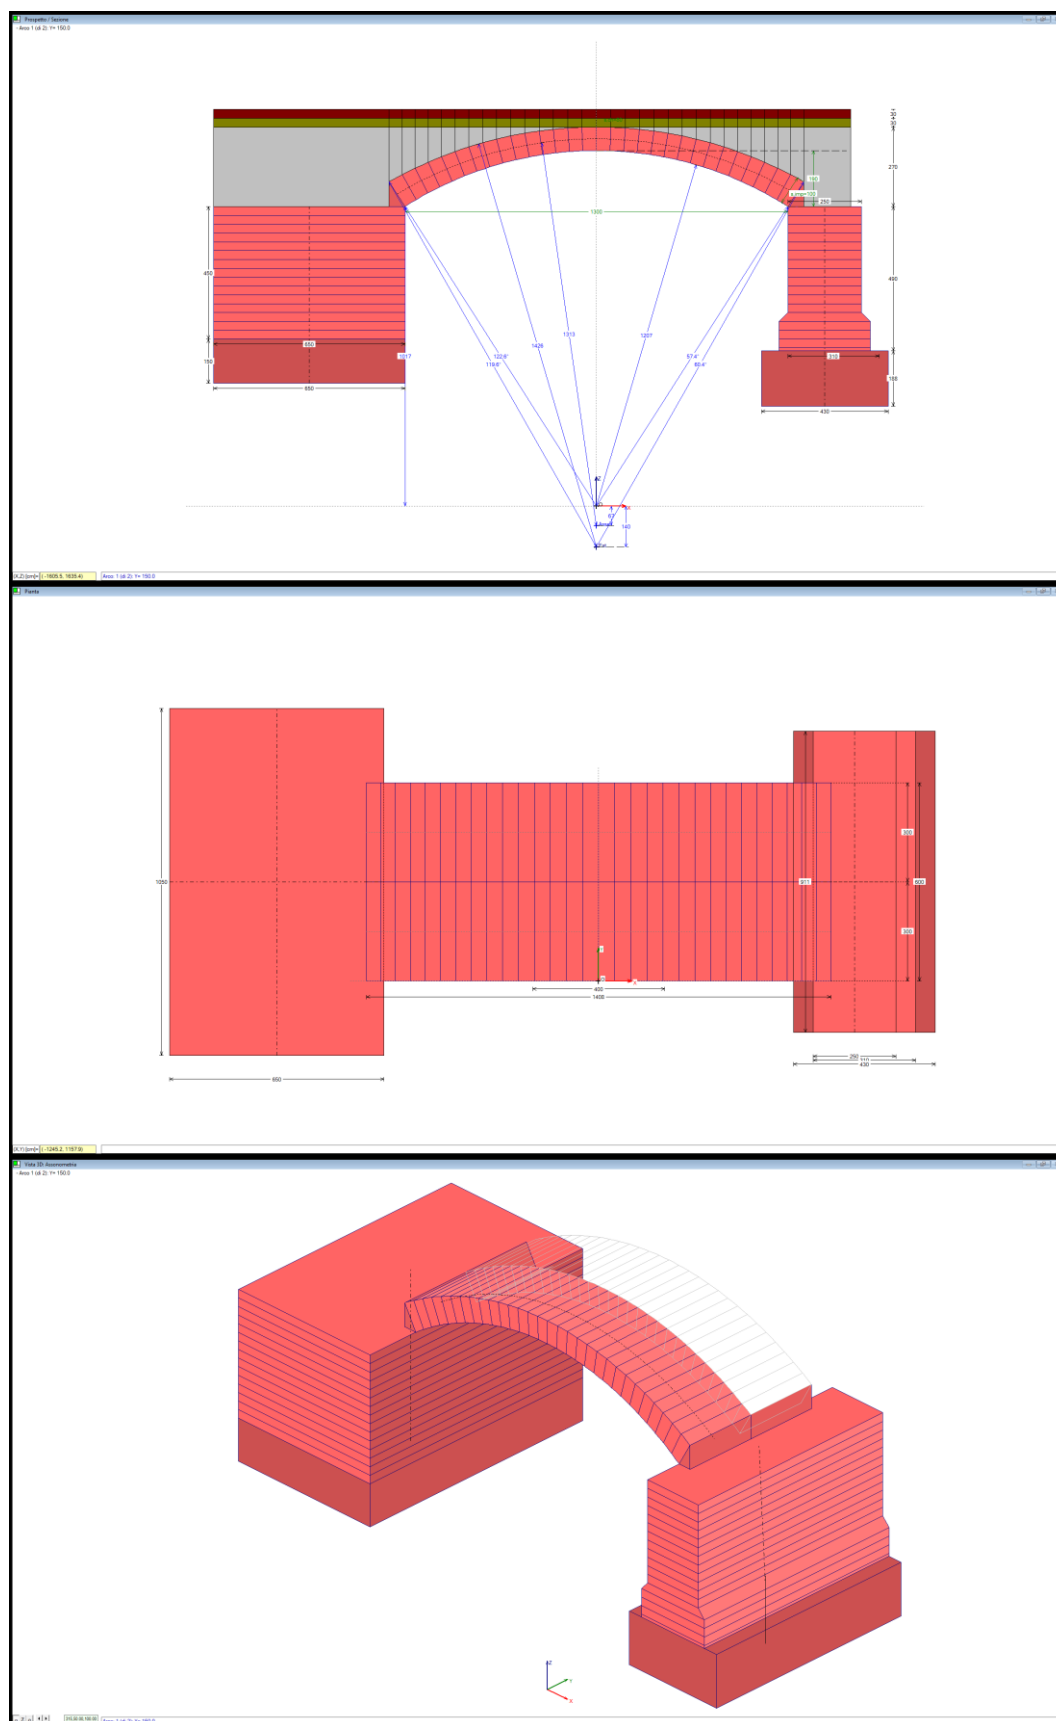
Modelli Ponte-Lanzo-R0\_SX-Fase1 e Ponte-Lanzo-R0\_SX-Fase2 – Prospetto, pianta e assonometria (dall'alto in basso)
